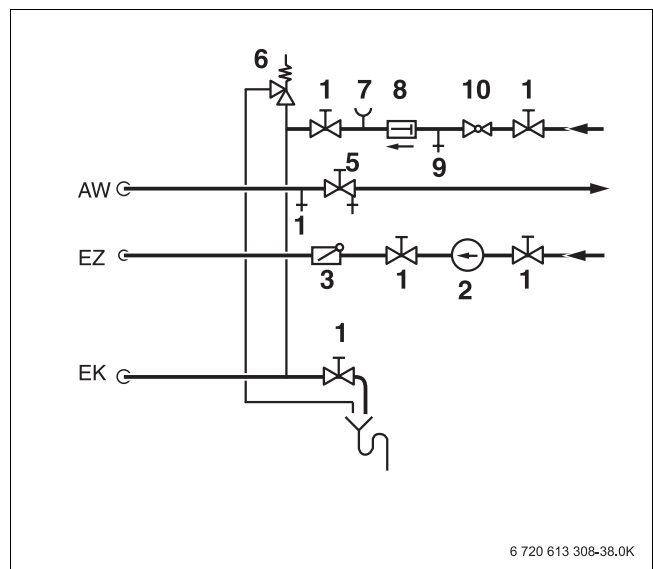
Installazione e apparecchiature rete idrica sanitaria
